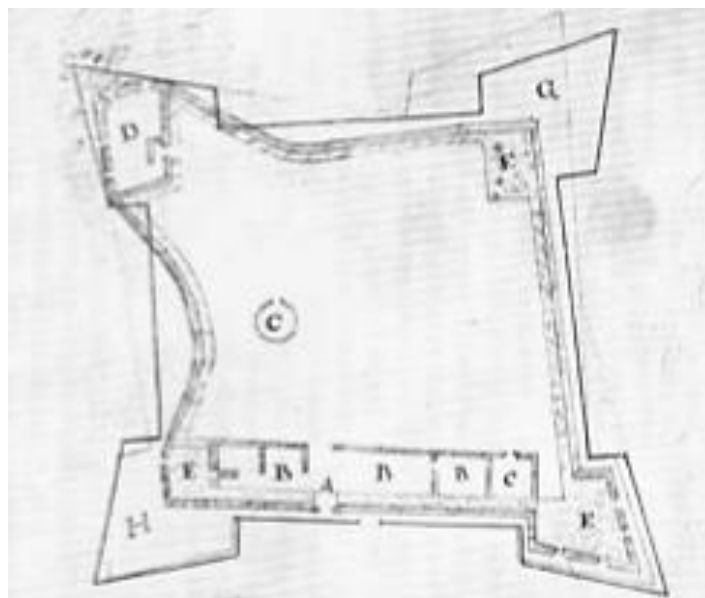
Planta do FCPB de 1696, com indicação de projeto de adequação do forte ao sistema construtivo militar de quatro baluartes.
